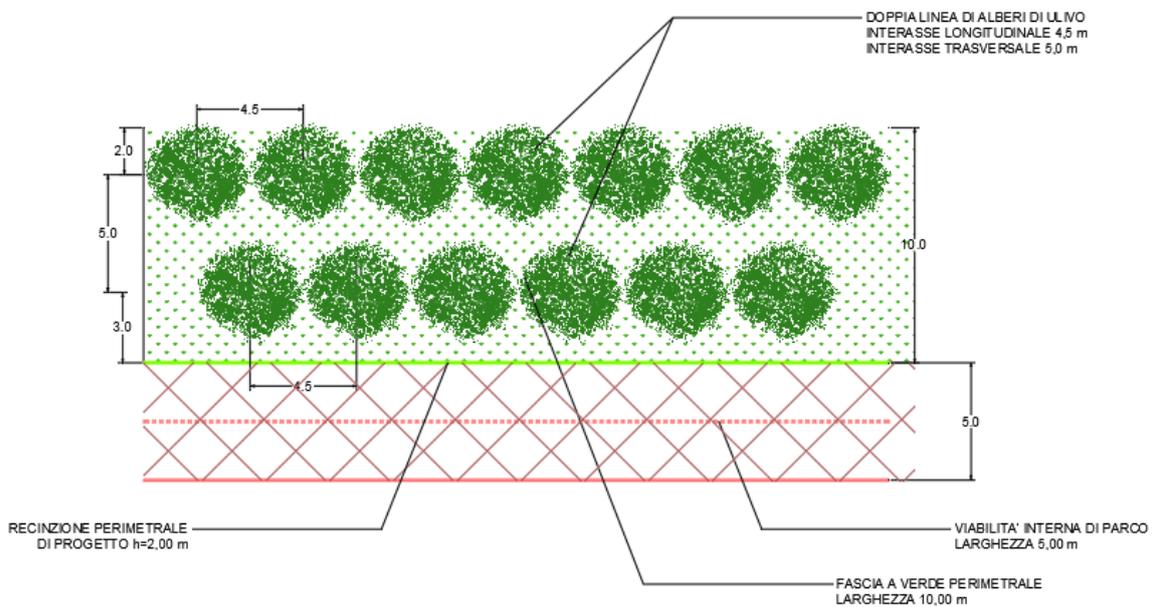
Stralcio dell'elaborato grafico PD-G.2.3.11 – Schema planimetrico
